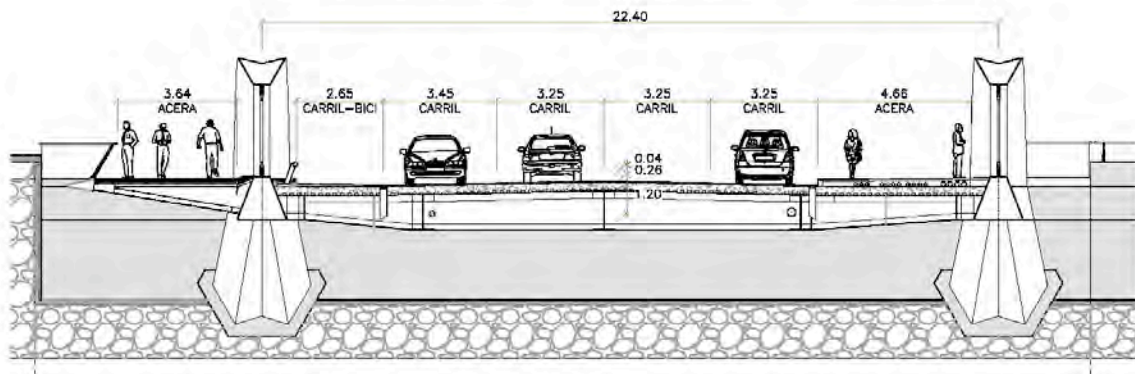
Sección transversal. Vista hacia el estribo de la margen derecha.
